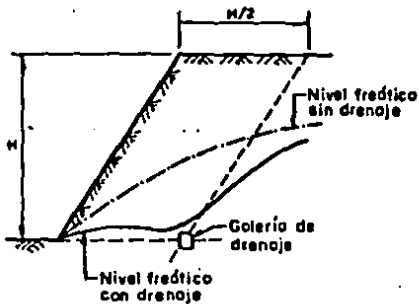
Emplazamiento de una galería de drenaje bajo un talud
